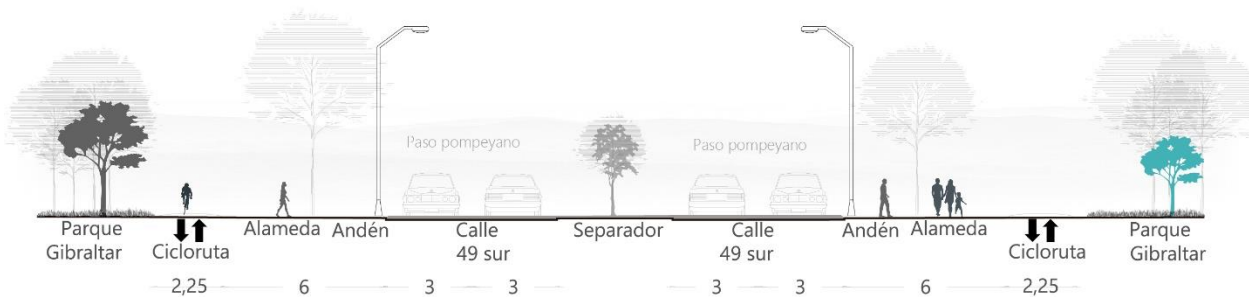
Perfil propuesto Avenida Santa fé Propuesta de perfil vial sobre Avenida Santa fé. Elaboración propia. (2020).
